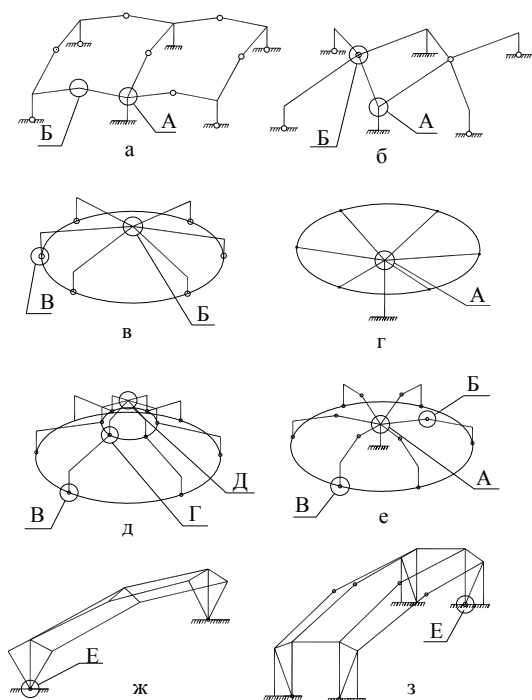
Конструктивные схемы каркасов сооружений из железобетонных рам: *а* – блок –модуль из четырех рам; *б* – блок –модуль из двух рам; *в* – схема каркаса круглого в плане; *г* – схема каркаса круглого в плане с единственной стойкой; *д* – схема каркаса круглого в плане типа башня; *е* – схема каркаса круглого в плане с центральной стойкой; *ж* – схема каркаса из трех рам; *з* – схема каркаса из четырех рам; А, Б, В, Г, Д, Е – узлы соединений элементов каркаса
